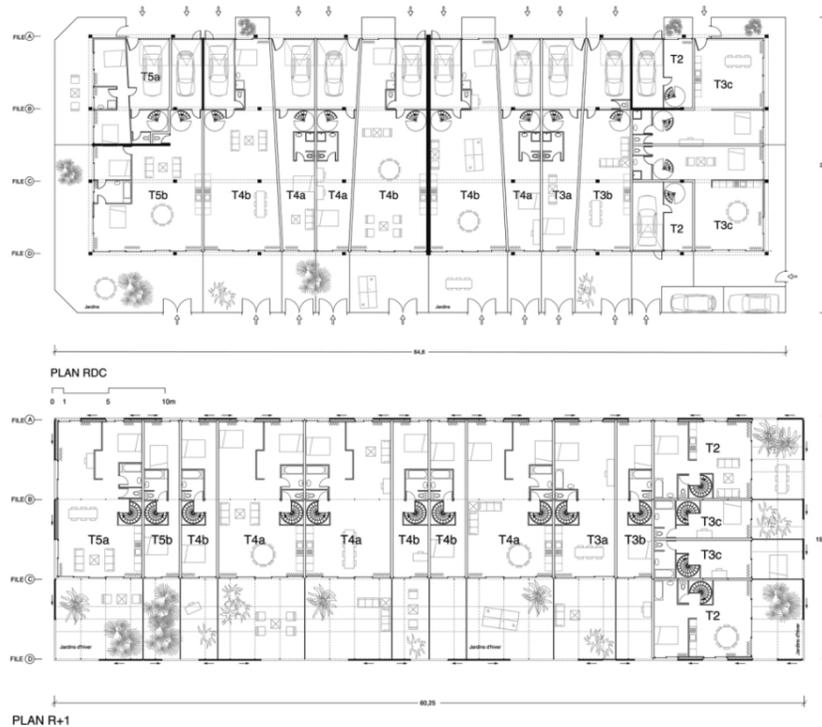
Planta Arquitectónica Vivienda Social Mulhouse
